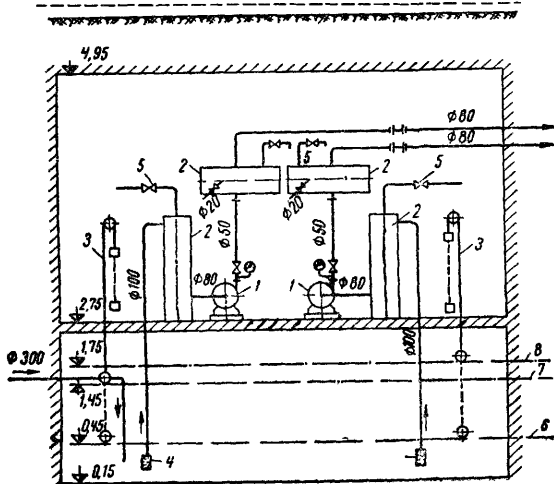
Схема дренажной насосной для удаления воды из системы попутного дренажа
